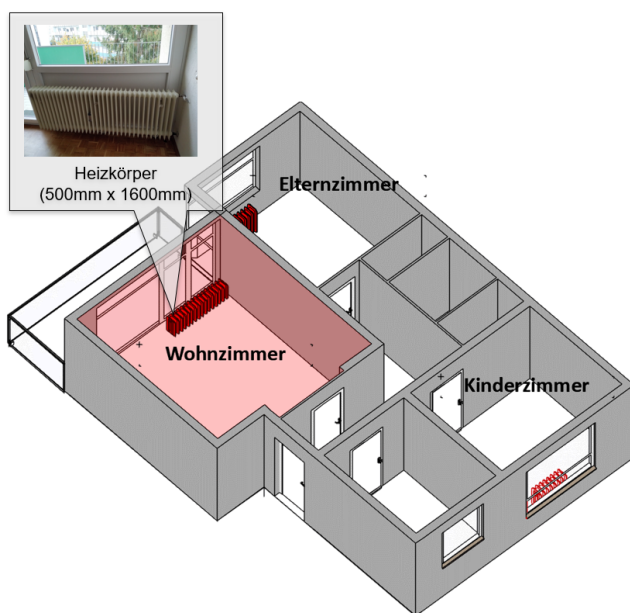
Grundriss Wohnung 4 und Fokus Wohnzimmer mit Abbildung Heizkörper
